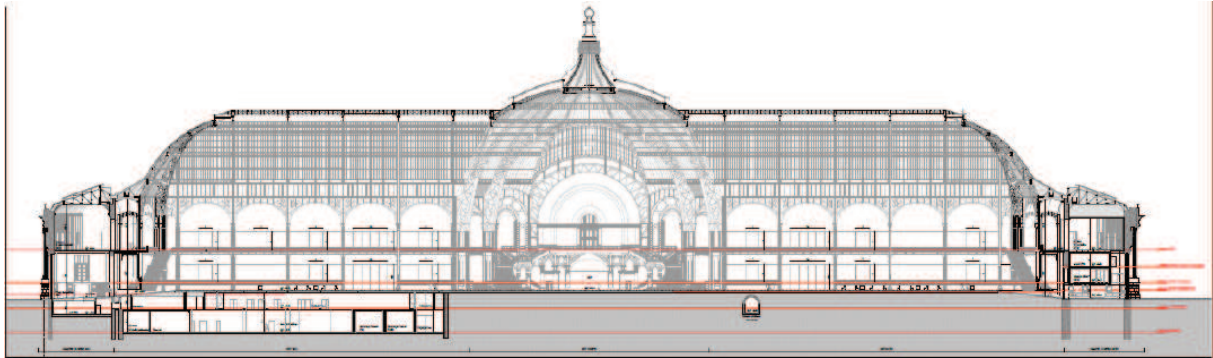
Plan de coupe : zone logistique située en sous-sol au Sud de la Nef © LAN
